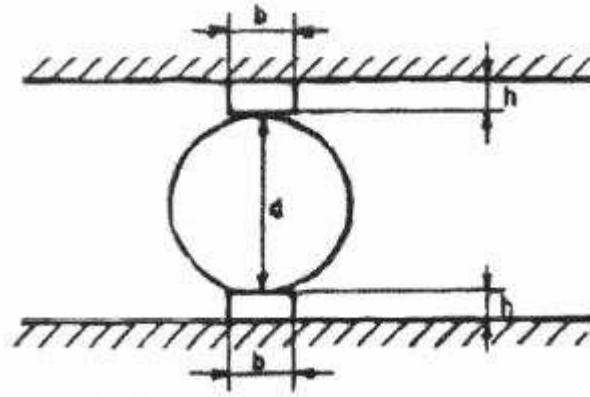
Disposição do corpo-de-prova para ensaio de tração
